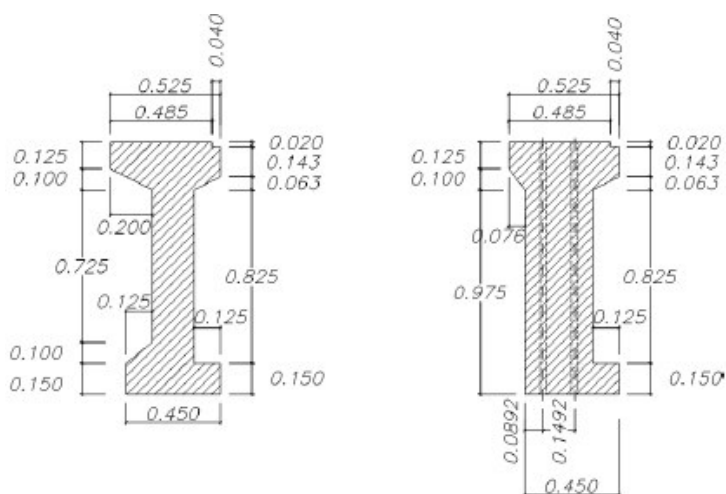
Secção transversal das vigas a meio vão e sobre o pilar [14].
